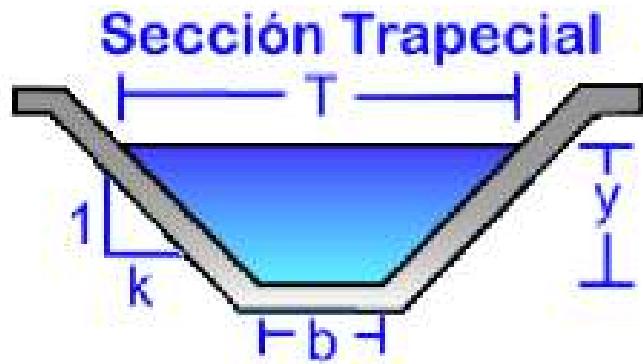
Sección trapezoidal (canales y cunetas de concreto o si revestimiento)
